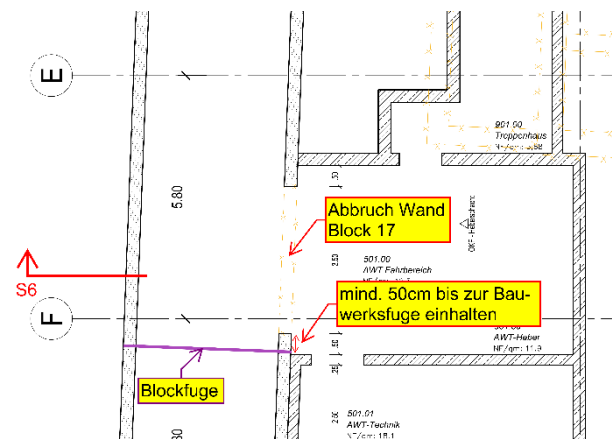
Grundriss UG, Auszug aus
